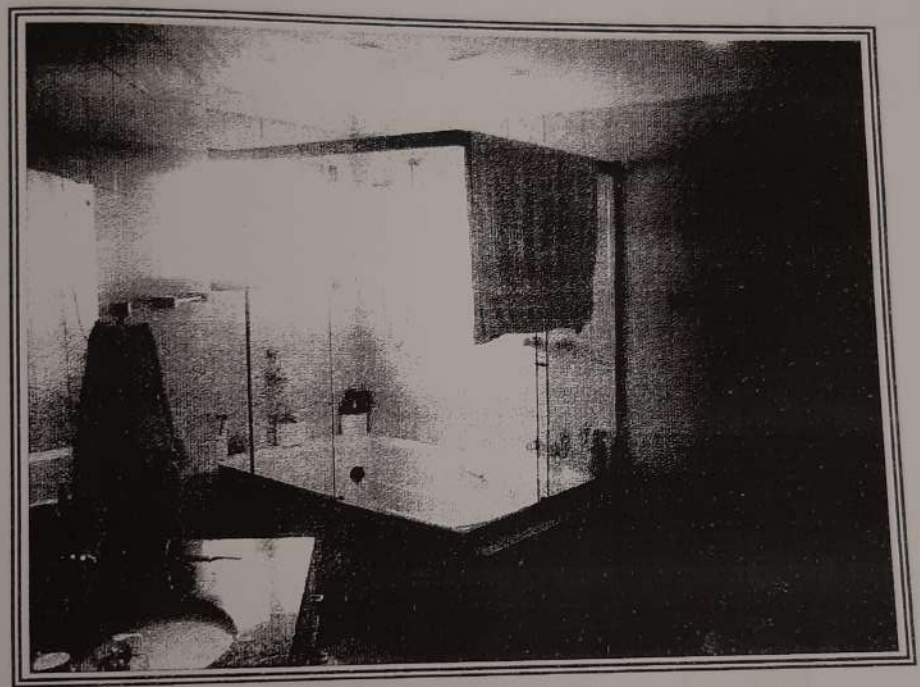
Vista do banheiro do dormitório 01 (suíte máster)
